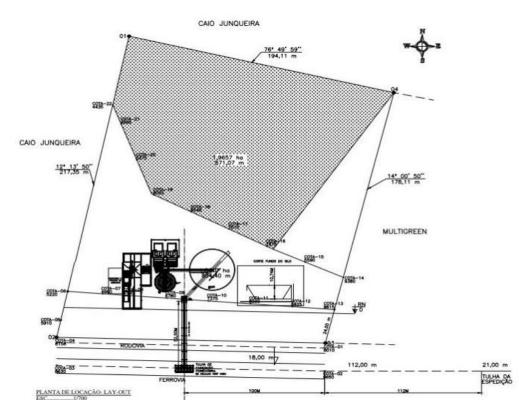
Planta de locação do Terminal do Lote 4 em Porto Franco.
